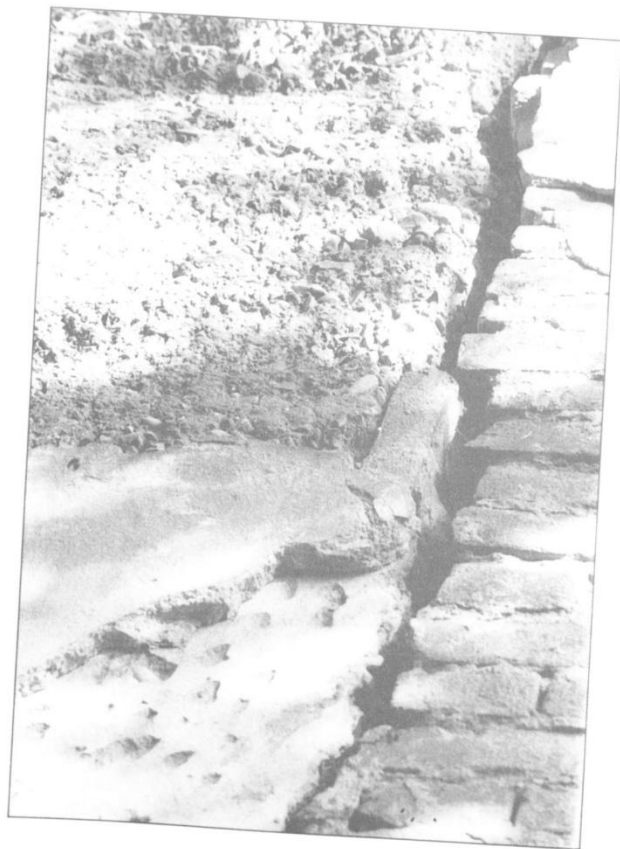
Particolare della lesione fra blocco di terra e il pilastro in muratura, la causa è da ricercare nel ritiro della terra battuta. Si nota un primo strato d'intonaco picchiettato per fare aderire un'altro intonaco più recente.
